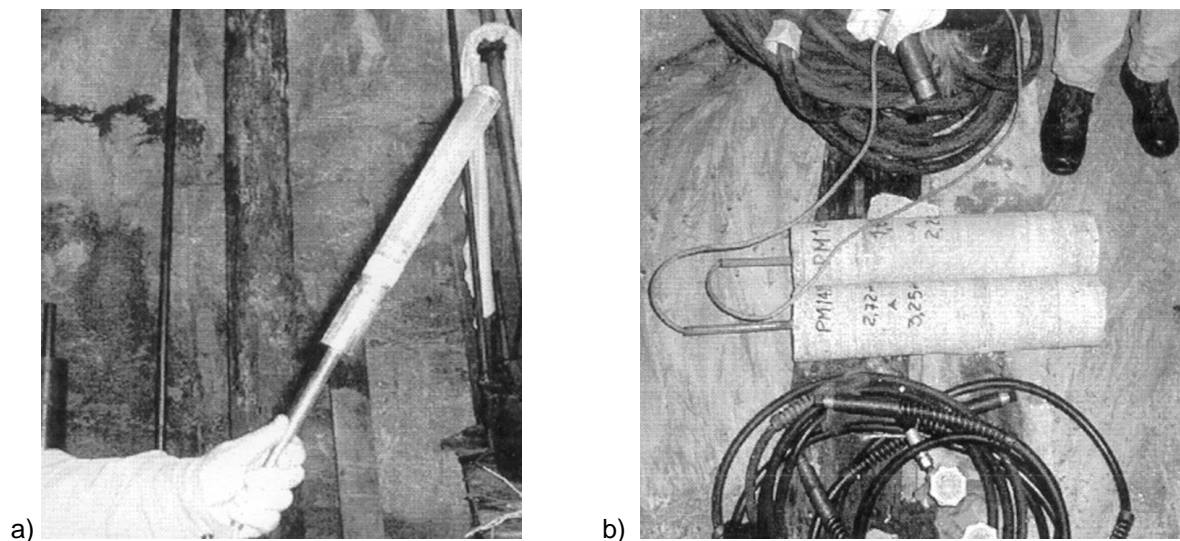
Ensaio STT: a) defórmetro antes de colocado no furo; b) exemplares após sobrecarotagem.
